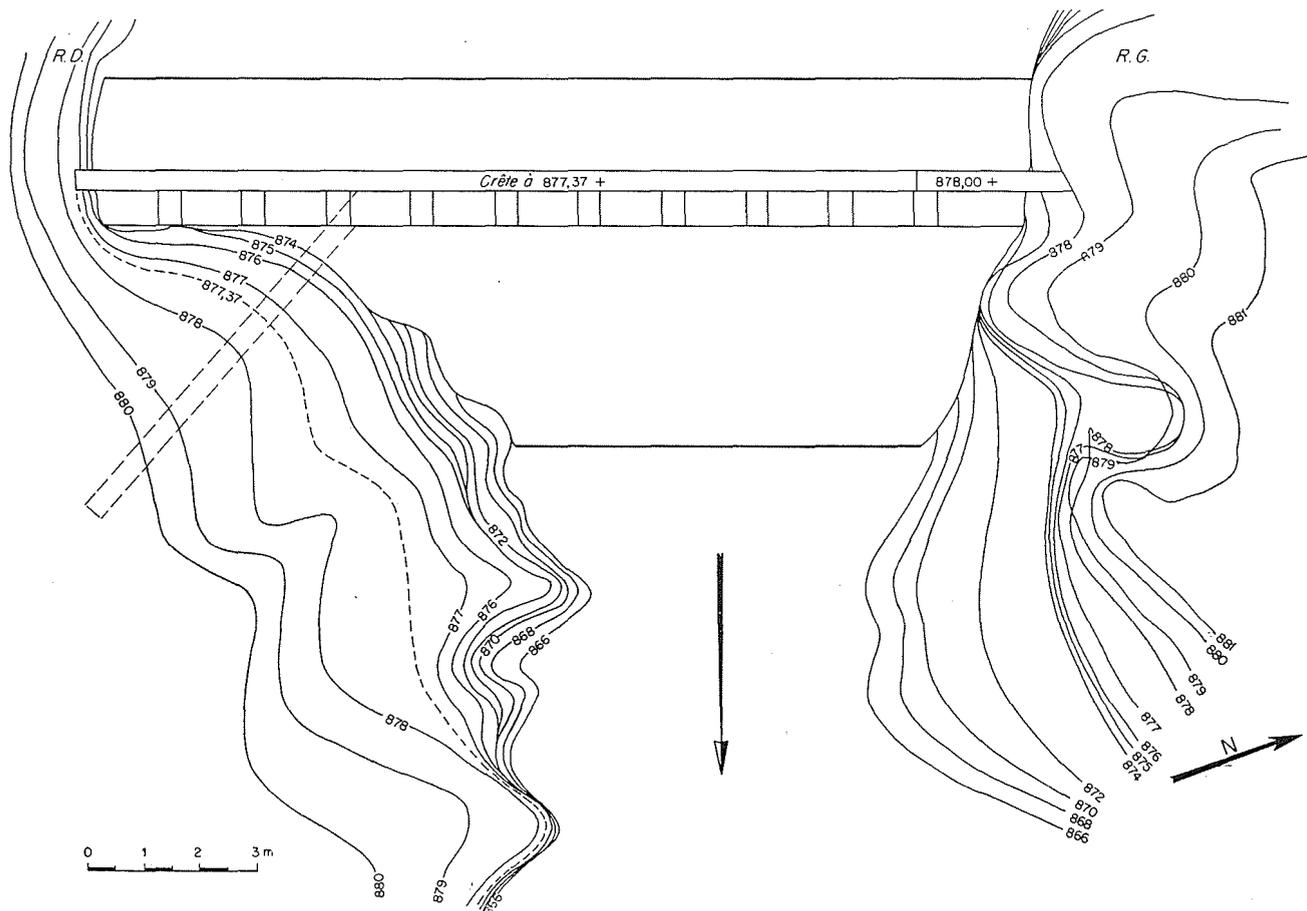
PLAN DU BARRAGE DE LUCHADOU.
